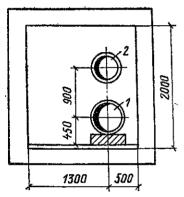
Схема укладки в туннеле водопроводных труб большого диаметра
